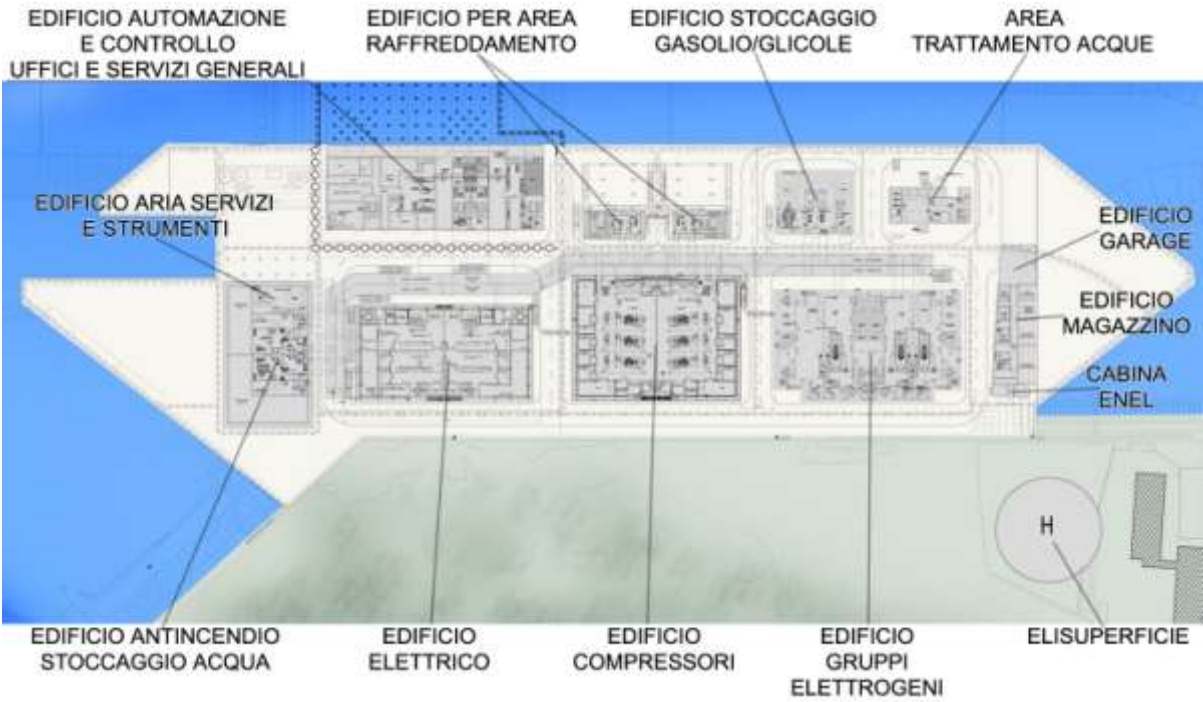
AREA IMPIANTISTICA PRINCIPALE DI CHIOGGIA SPALLA SUD
